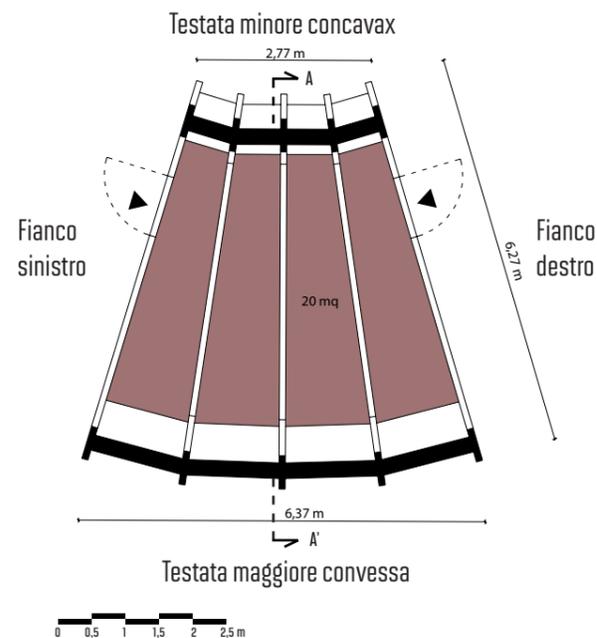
a: PLANIMETRIA DEL BOX
